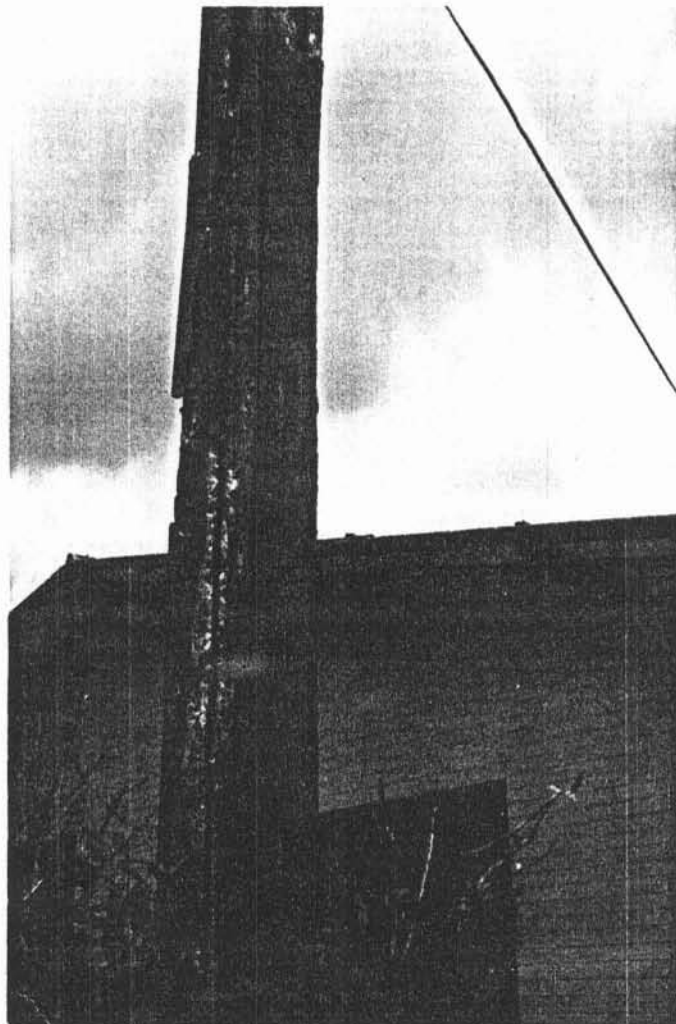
Lascamento do concreto devido às forças de expansão dos produtos de corrosão.
